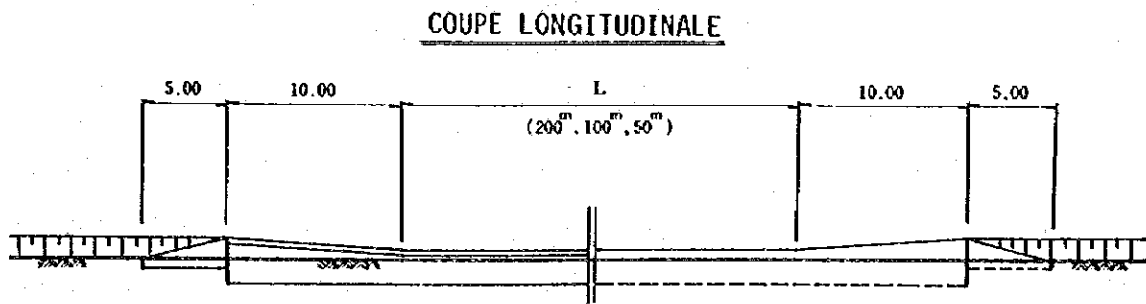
11 PLAN DES RADIERS SUBMERSIBLES
